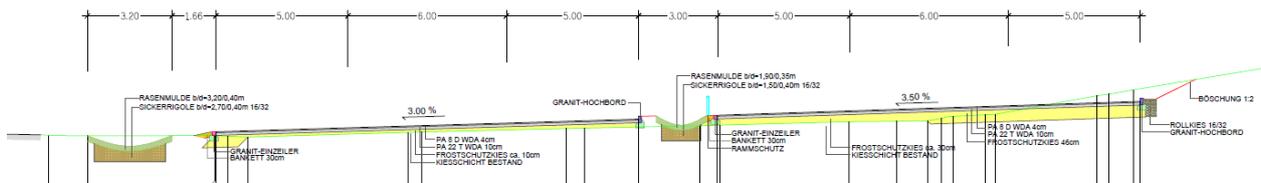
Schnitt Parkplatz Nord (N3, Auszug aus dem Lageplan IB BG Trauntal, technischer Ausführungsplan ohne Bepflanzung)
